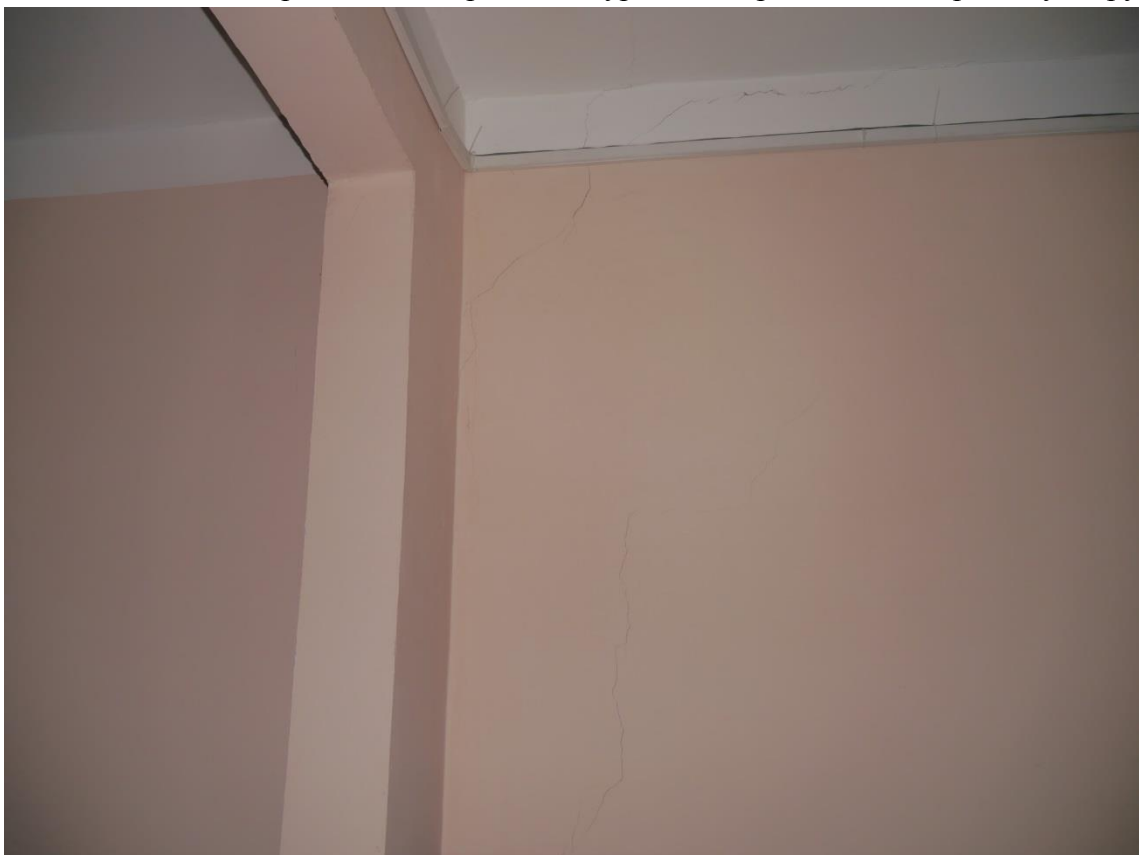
Трещины во внутренней несущей стене по оси «П», в месте примыкания к ней перегородки, в уровне 10-го этажа.
